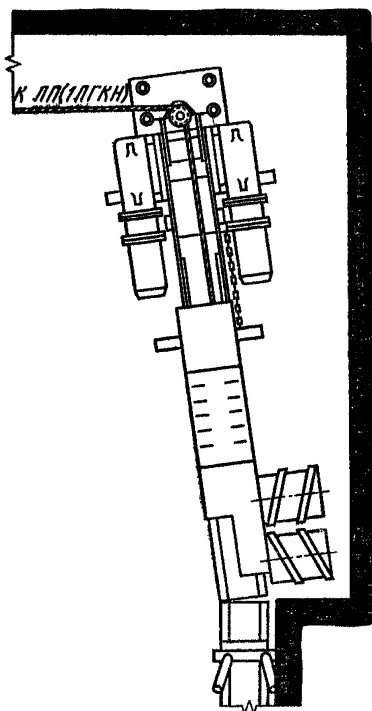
Крепление конвейера ниже головки двумя стойками, установленными на деревянный брус
